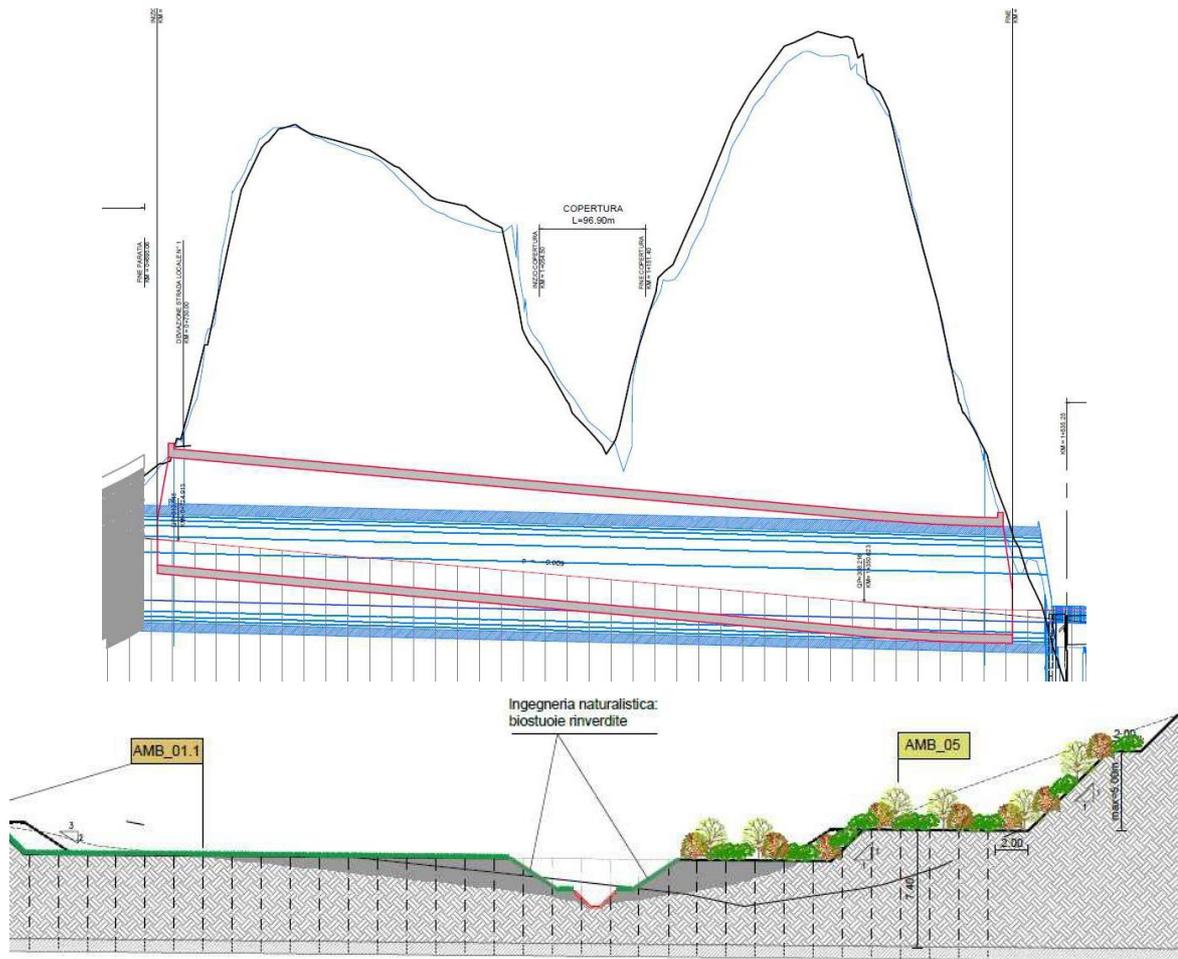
Sovrapposizione PD2003 – PD 2021: profilo altimetrico e rimodellamento galleria il Monte
